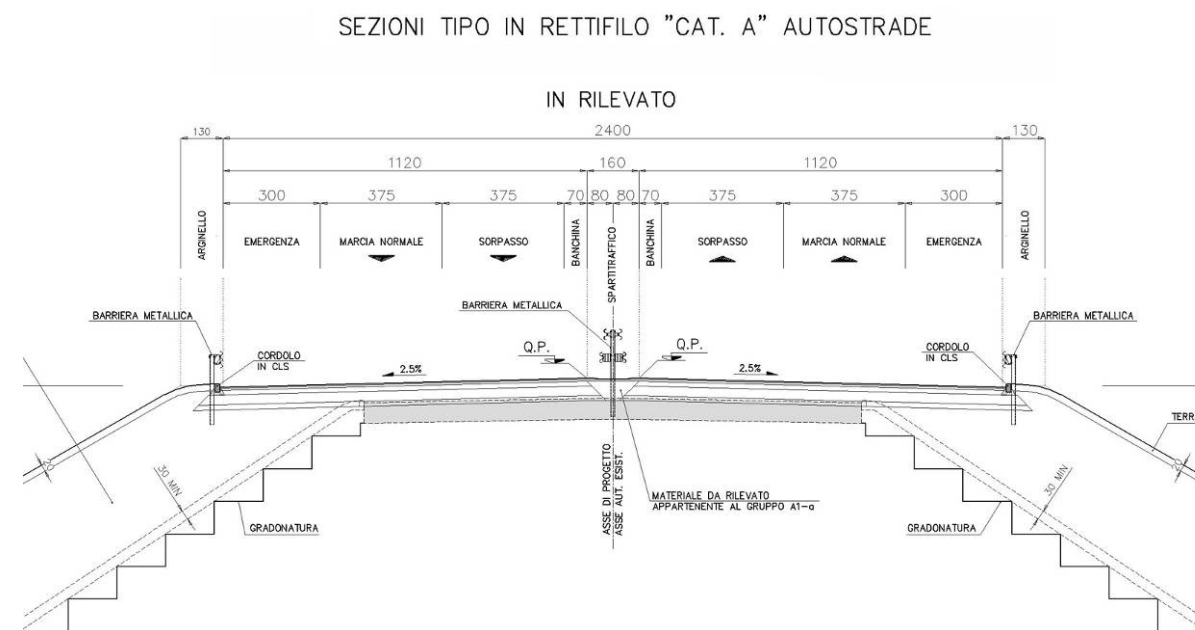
Sezione tipo di progetto ( adeguamento simmetrico Variante SS1 Aurelia)
